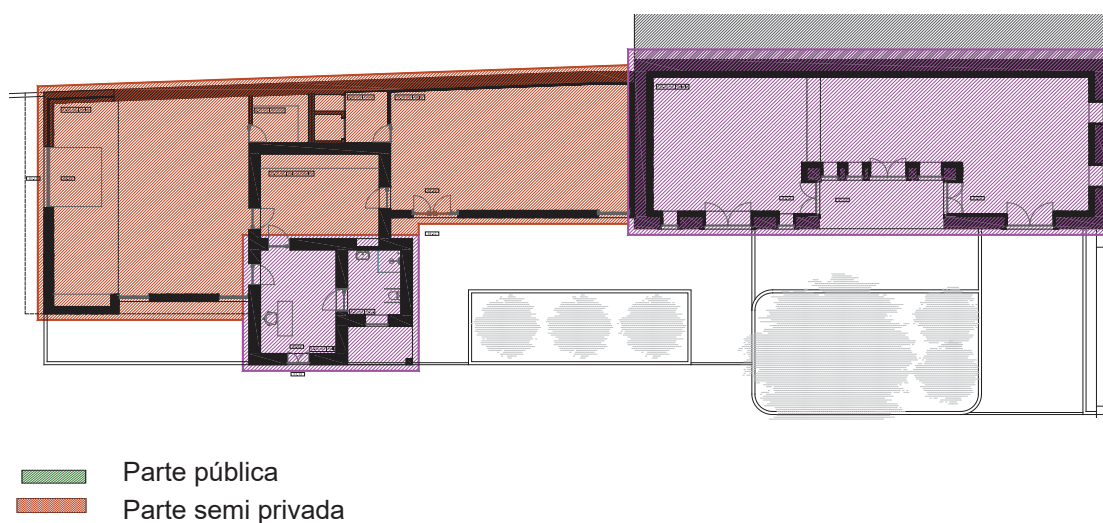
Planta de parte semi privada e pública da nova intervenção.
